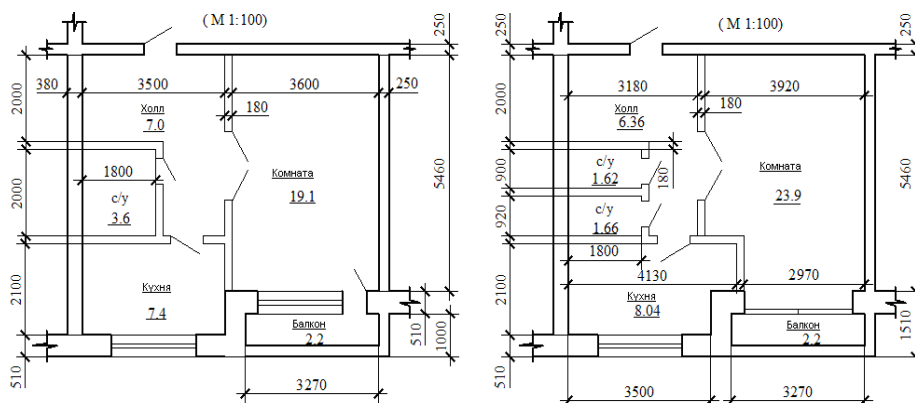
Четвертый вариант перепланировки однокомнатной квартиры
